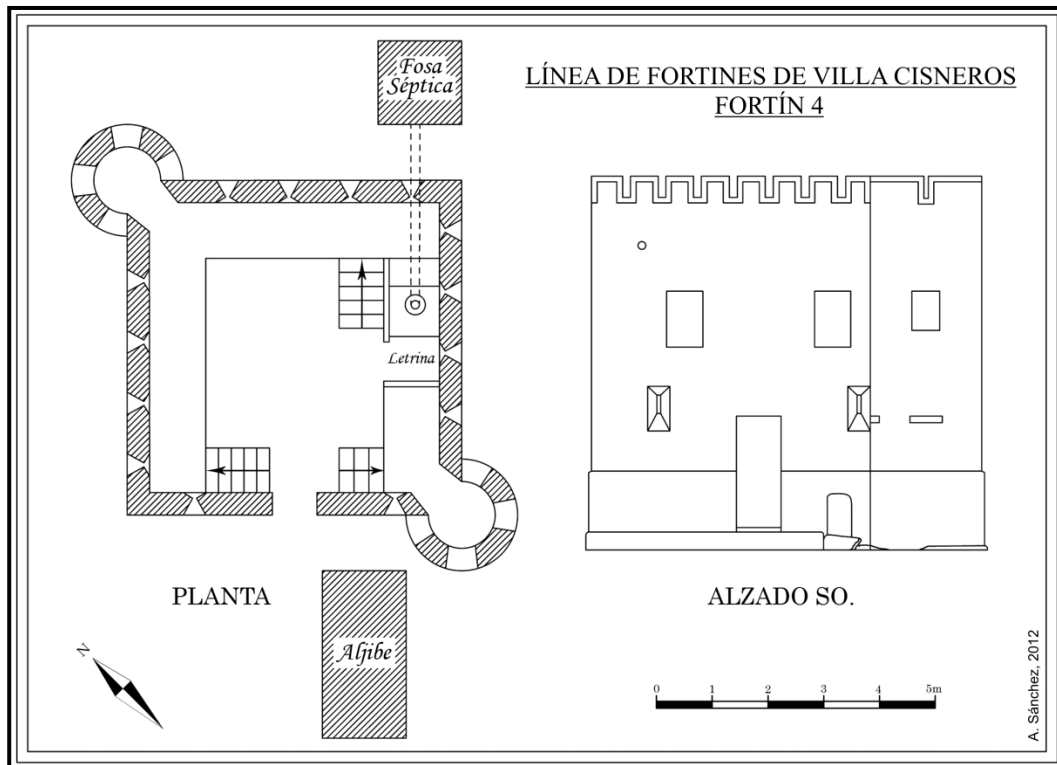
Planta interior y alzado SO del Fortín 4 (A. Sánchez, 2012).
